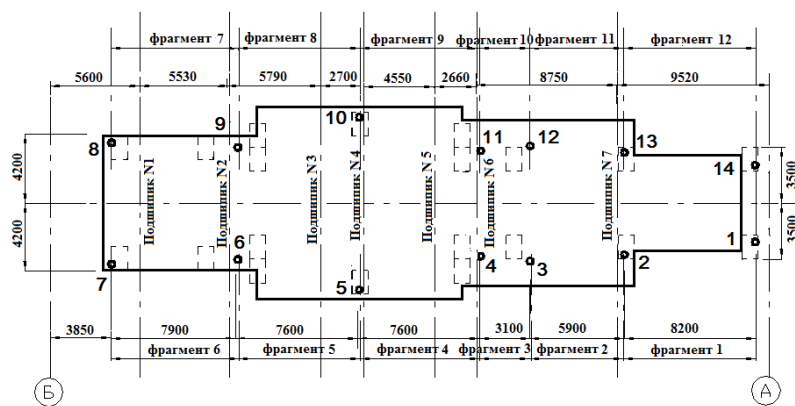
Схема расположения осадочных марок фундамента ТГ-1 на отметке +9,6 м / Location scheme sedimentary marks the foundation of TG-1 at the level of +9.6 m
